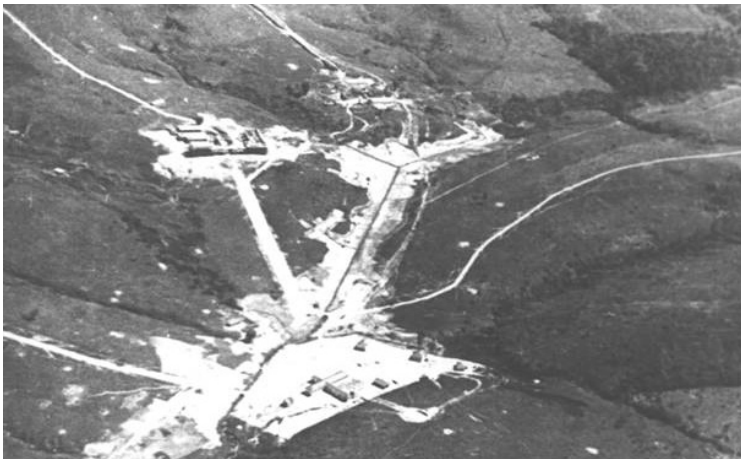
Vista aérea dos primeiros canais de saneamento, em 1939 (Foto Arquivo Moura Andrade)
